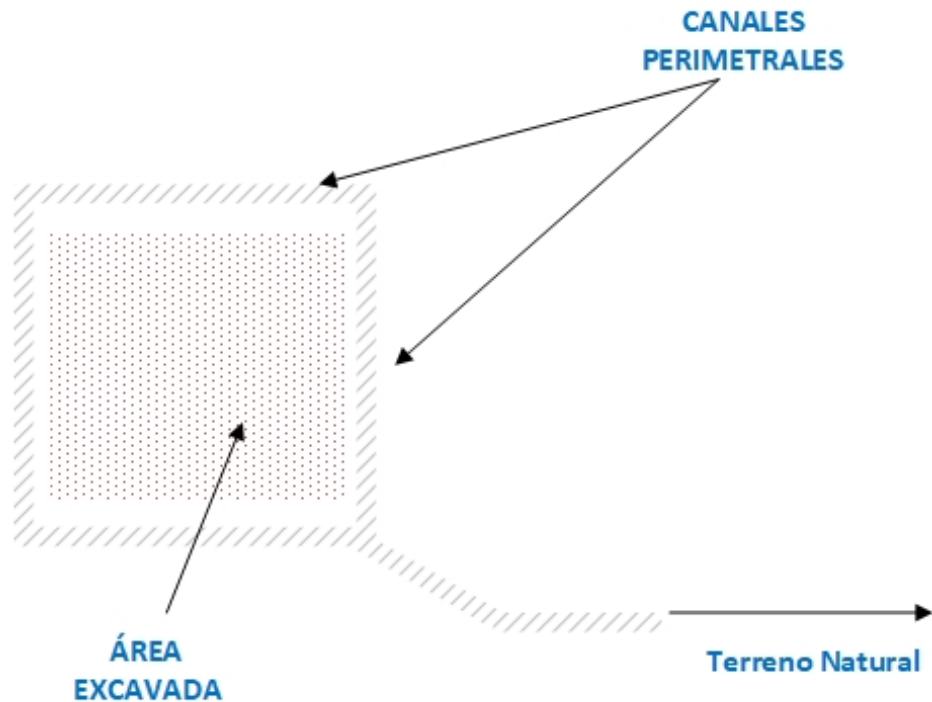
Esquema del Sistema de Drenaje Pluvial – Vista de Planta
